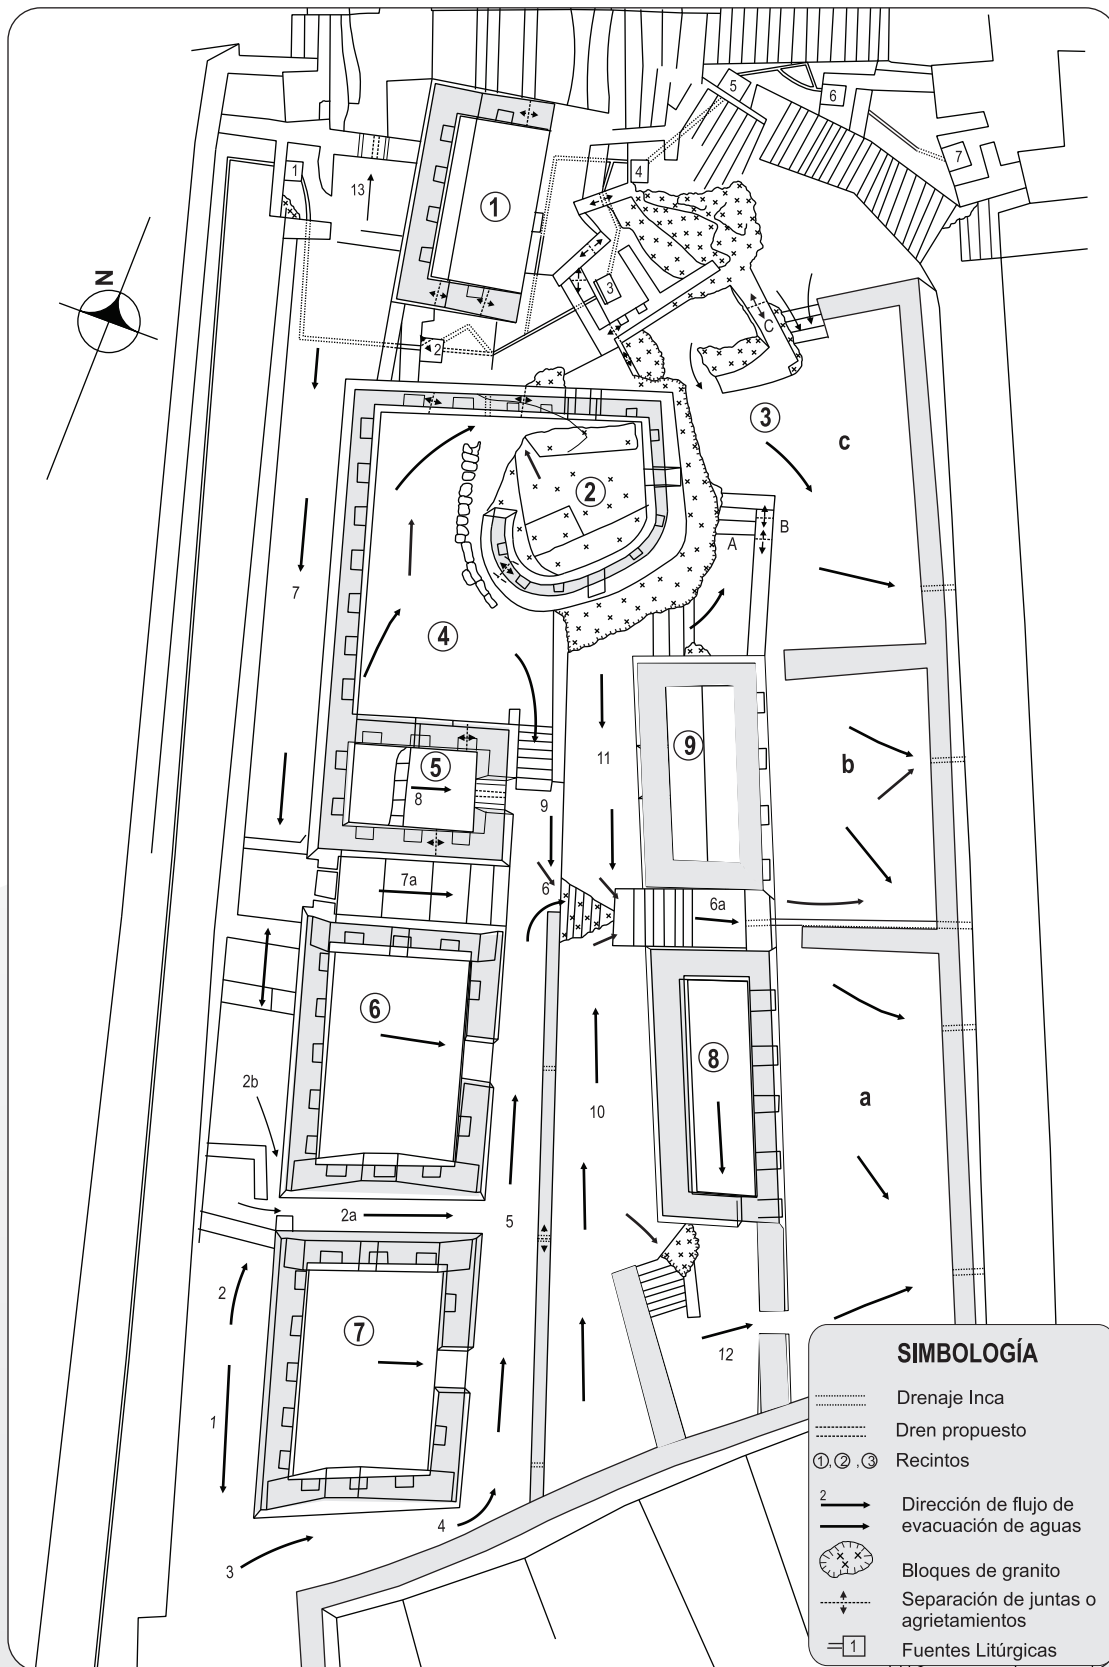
Propuesta de drenajes para el Conjunto 2, tomado y modificado de Carlotto et al. (1994b).
